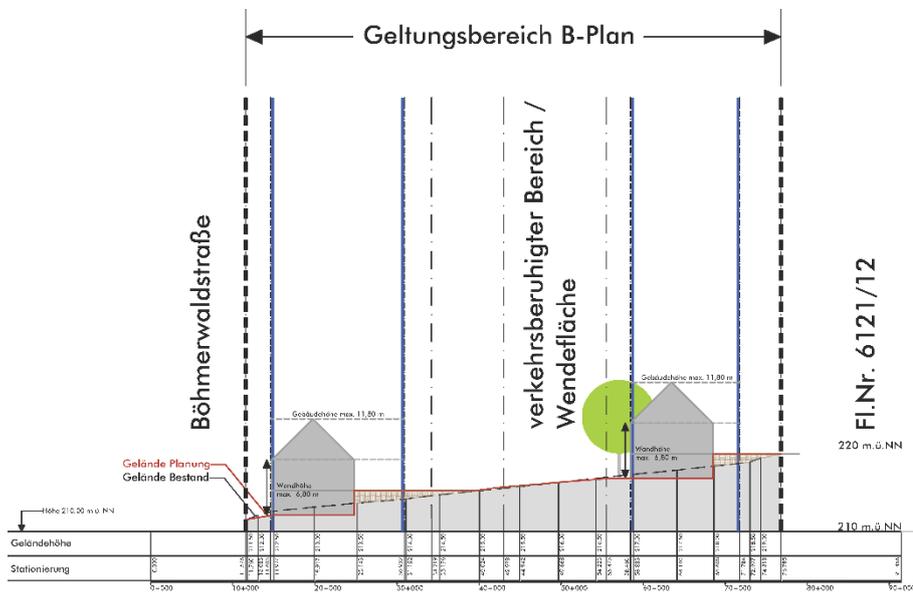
Schnitt A.A, Bebauung mit geschosshohem Versatz, unmaßstäblich
